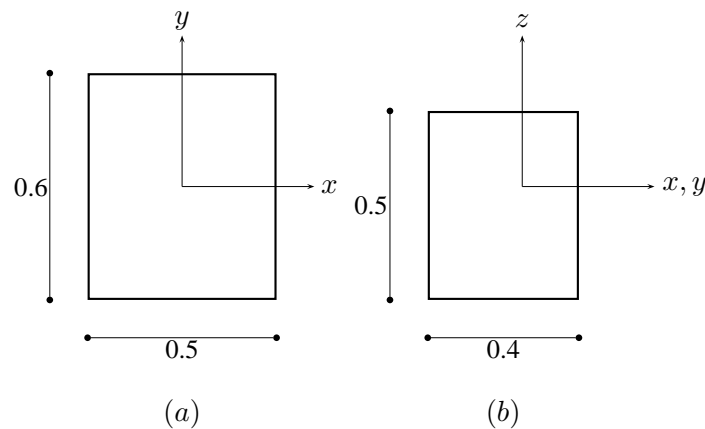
Secciones de las columnas (a) y las vigas (b).
